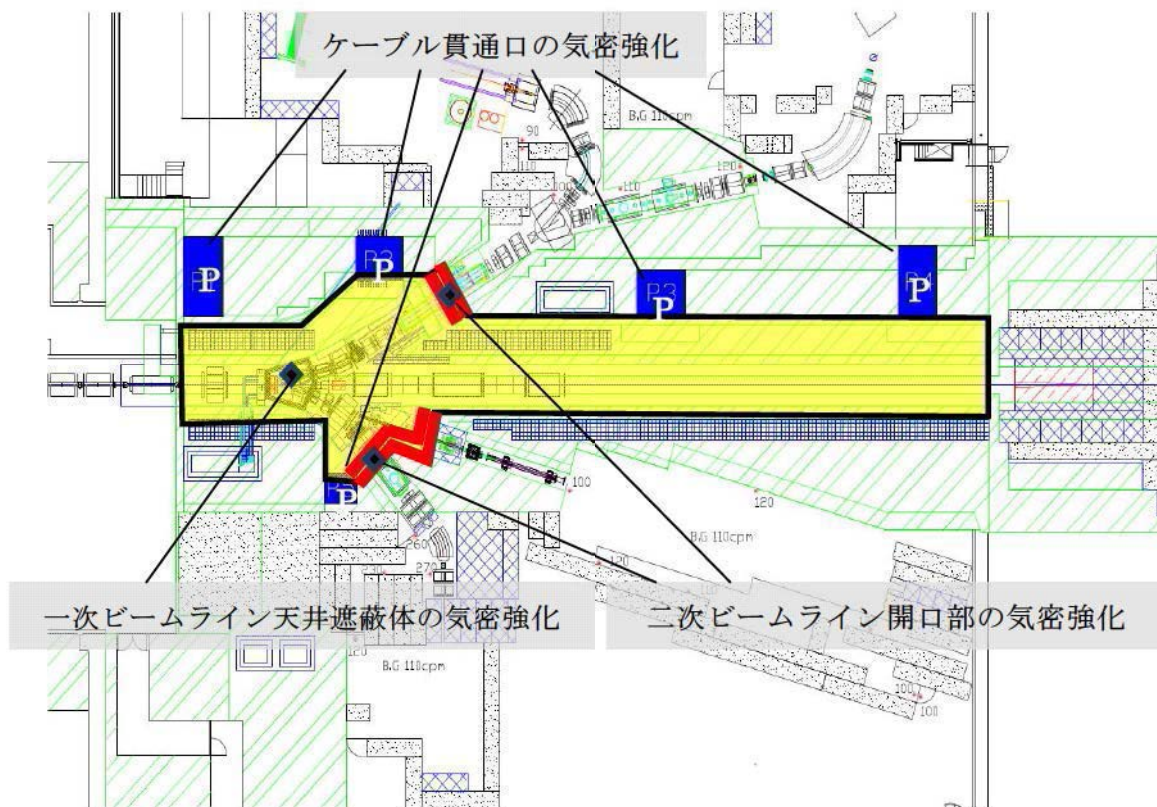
一次ビームライン室の気密強化案(平面図)
